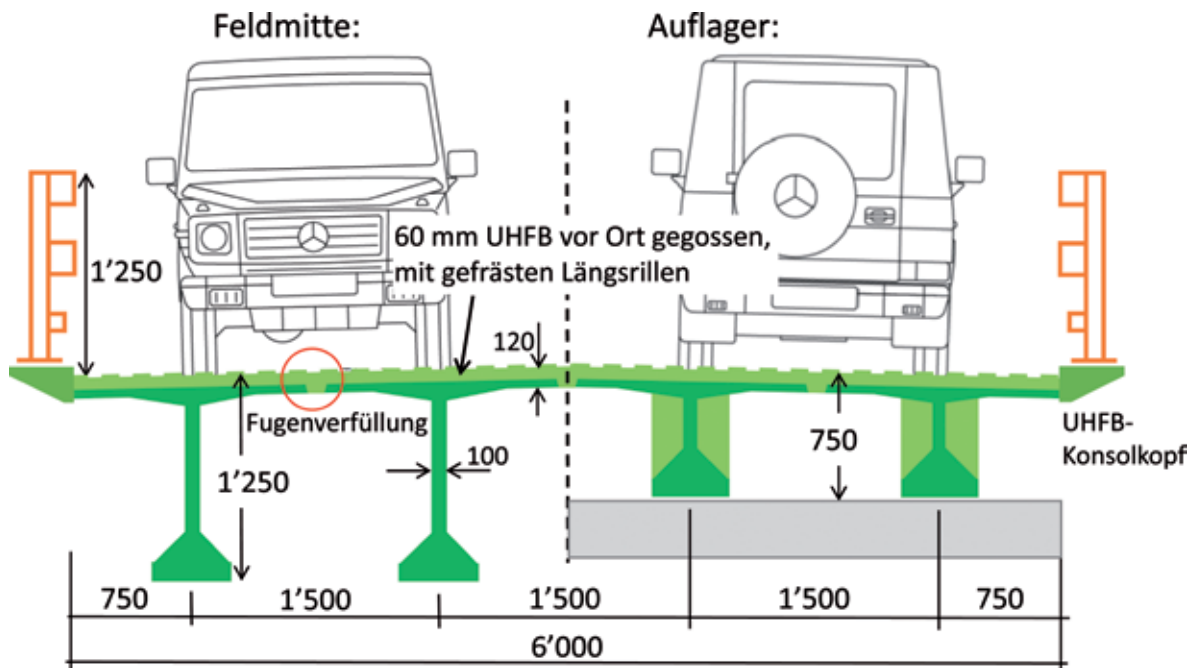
Stahl-UHFB-Straßenbrücke: Querschnitt (Vorprojekt) in Feldmitte und am Auflager, Variante mit schlaffer Bewehrung im Untergurt (2020) Zeichnung: E. Brühwiler
